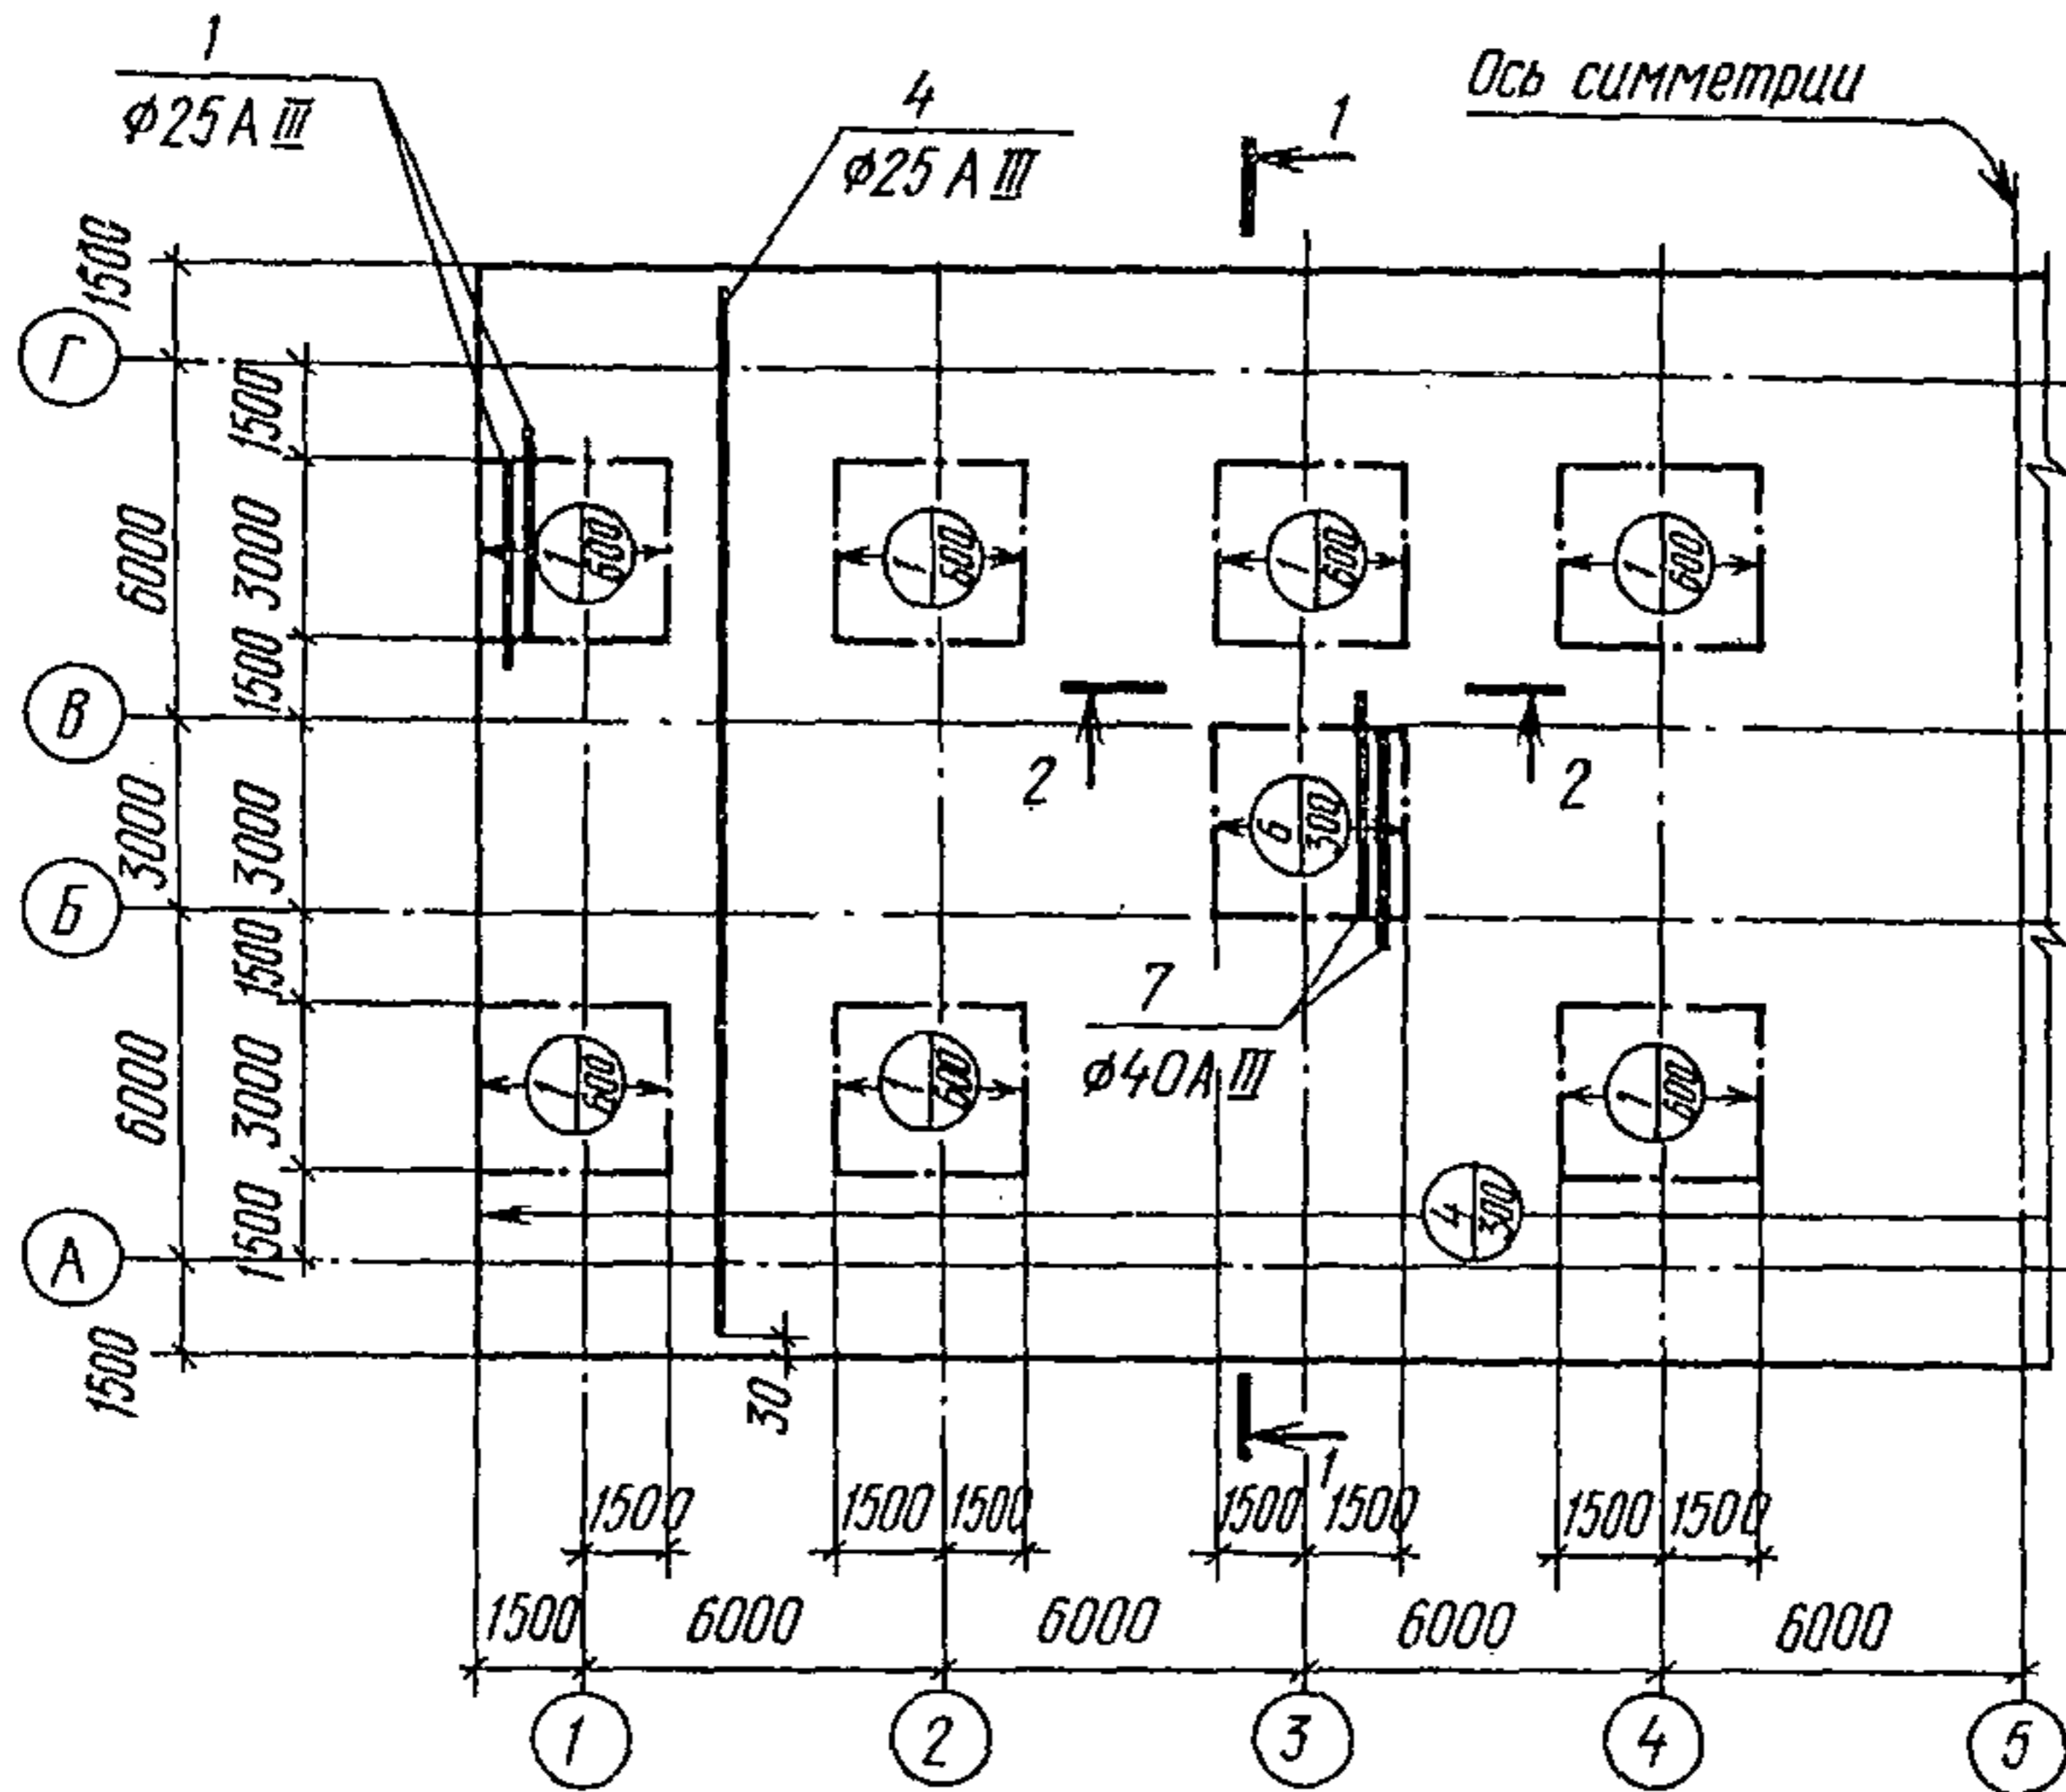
План раскладки арматуры второго слоя верхней зоны
